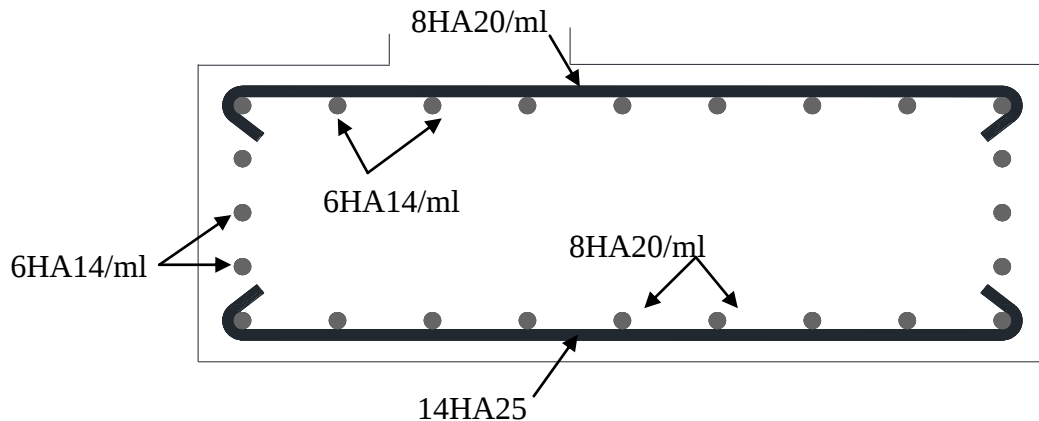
Ferrailage de la semelle (vue en élévation)
